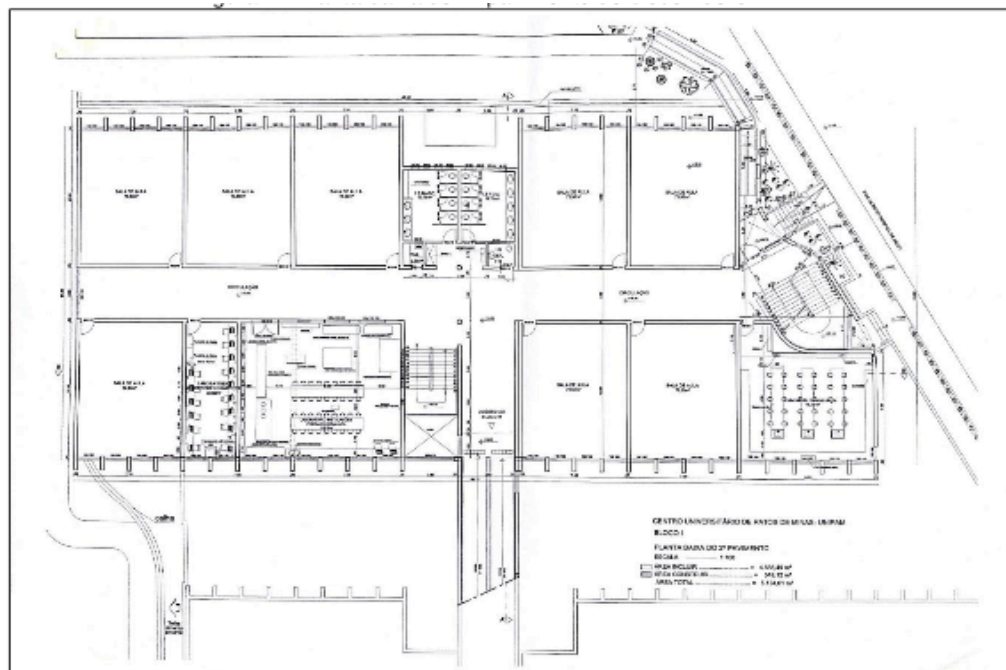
Planta baixa do 2º pavimento do bloco I do UNIPAM
